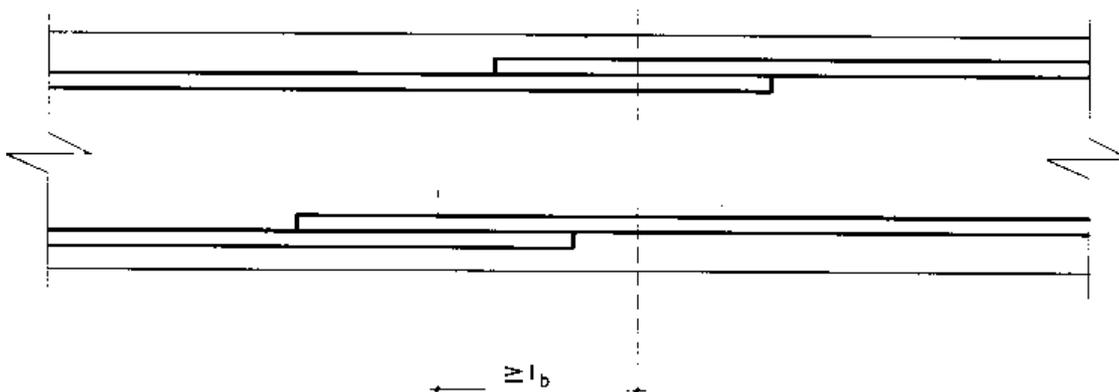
Empalmes de las distintas barras en tracción
